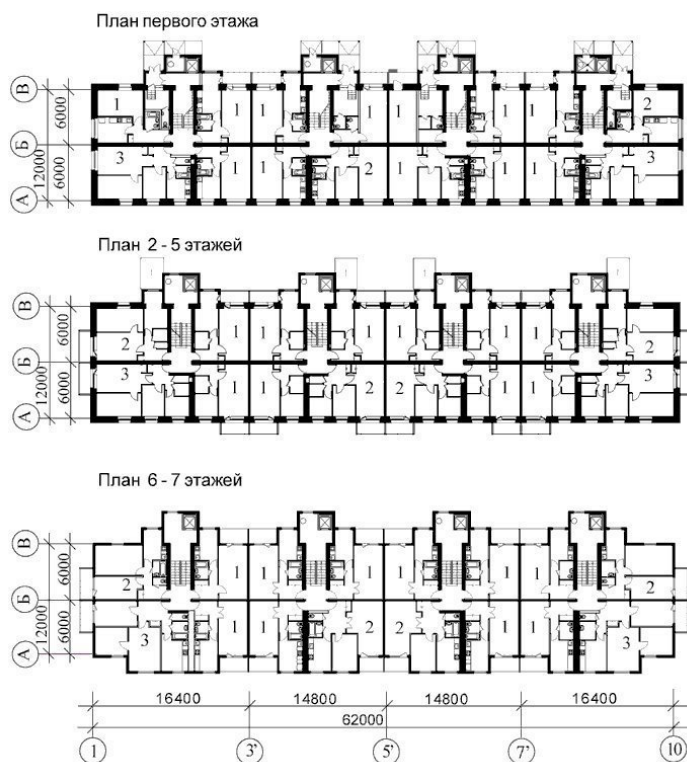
Проект реконструкции жилого здания серии 1.447. Планировки
